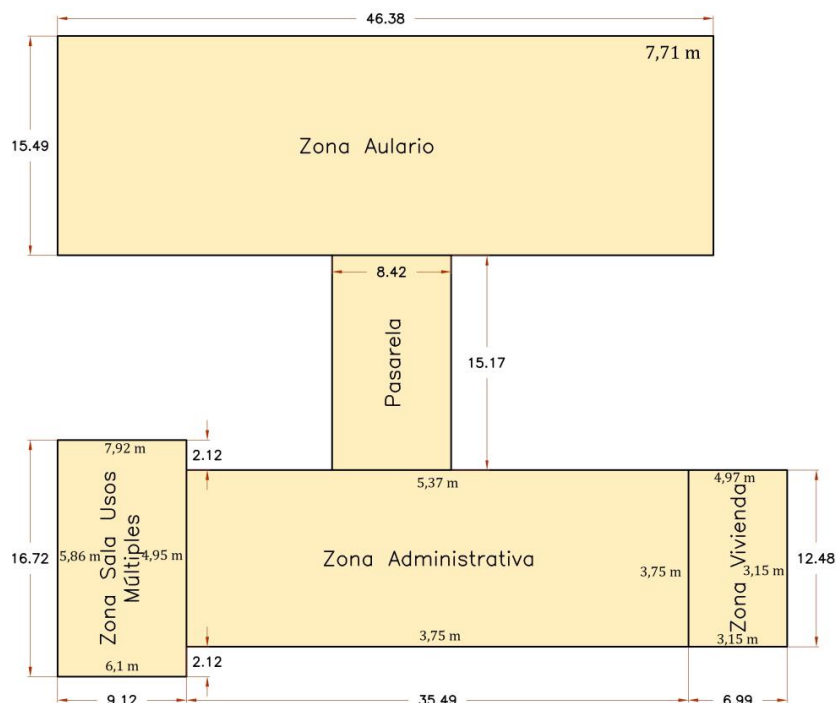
Croquis de vista en planta acotada con las medidas y alturas del proyecto
